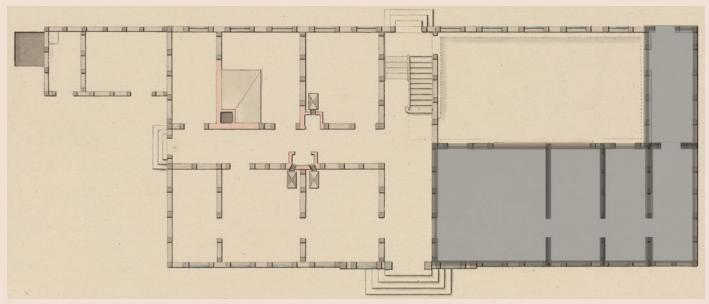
Rekonstruktion des Grundrisses 1883; Hervorgehoben ist die Hausmeisterwohnung.
